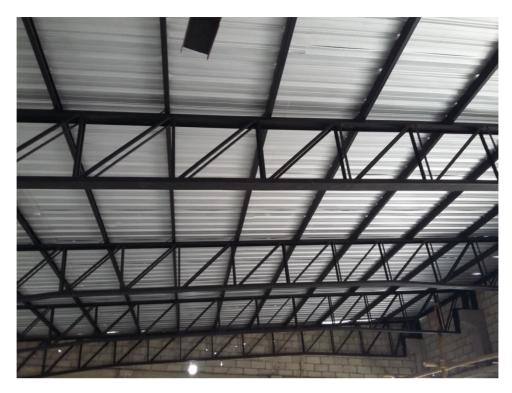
CONSTRUCCIÓN DE LA CERCHA METÁLICA TIPO HOWE.
